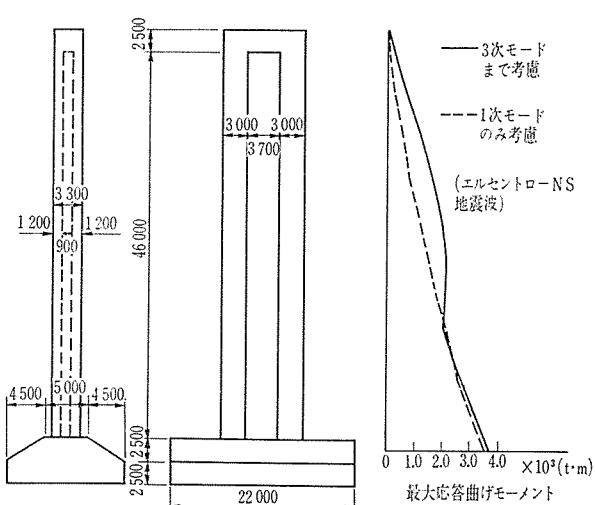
橋脚（鉄骨鉄筋コンクリート造）の動的解析例
